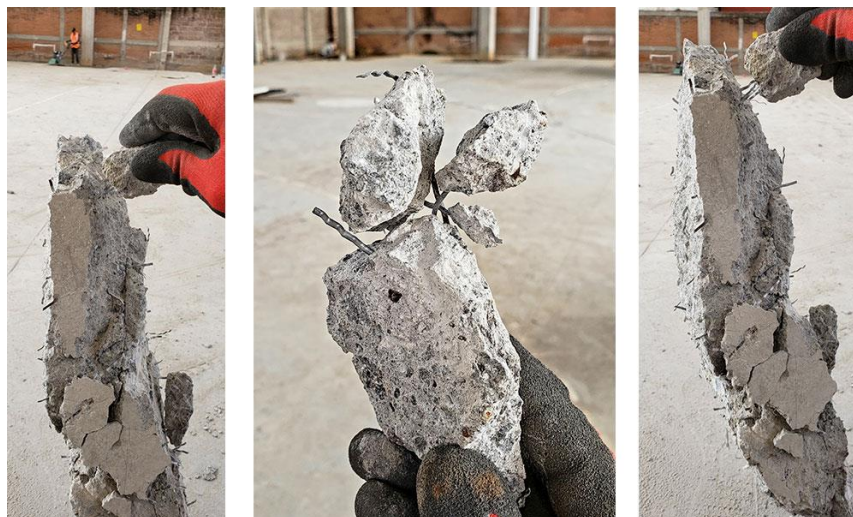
Estructura interna del hormigón reforzado con fibras de acero. Fuente: (PSI concreto, 2020).
